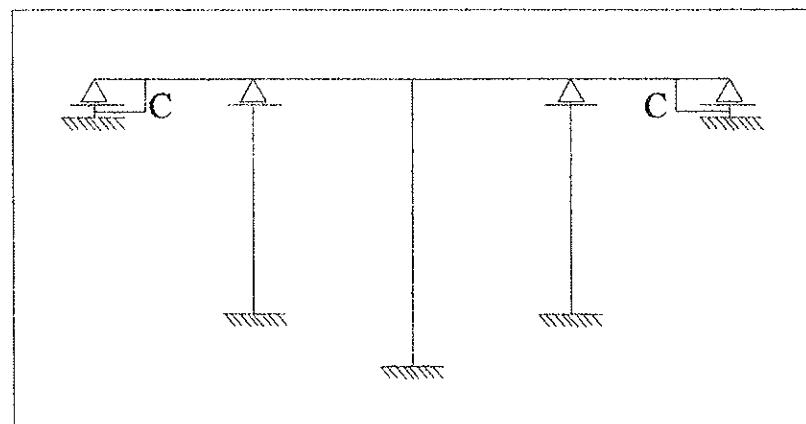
Estructura con la pila central empotrada al tablero y con conectores de distintas capacidades en los estribos.
